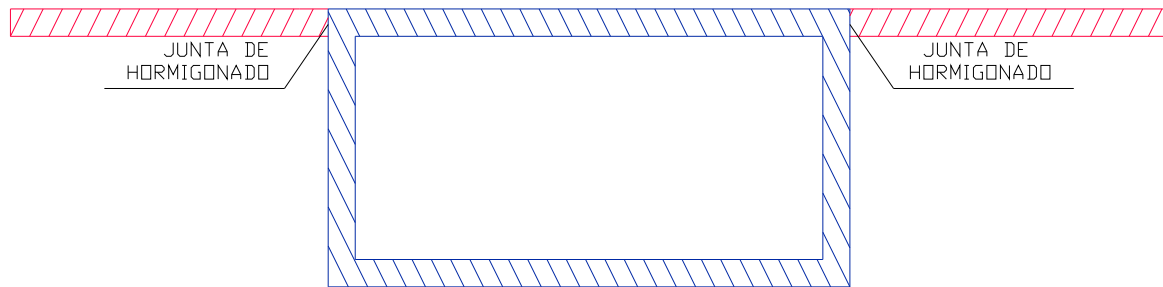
11. Junta de hormigonado planteada por suizos (1º fase en azul y 2º fase en rojo).
